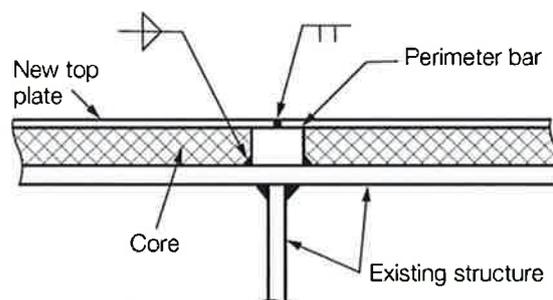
Abschluss einer Kavität durch aufgeschweißte Randleisten, die gleichzeitig Unterlage für den Schweißstoß der Oberbleche sind
